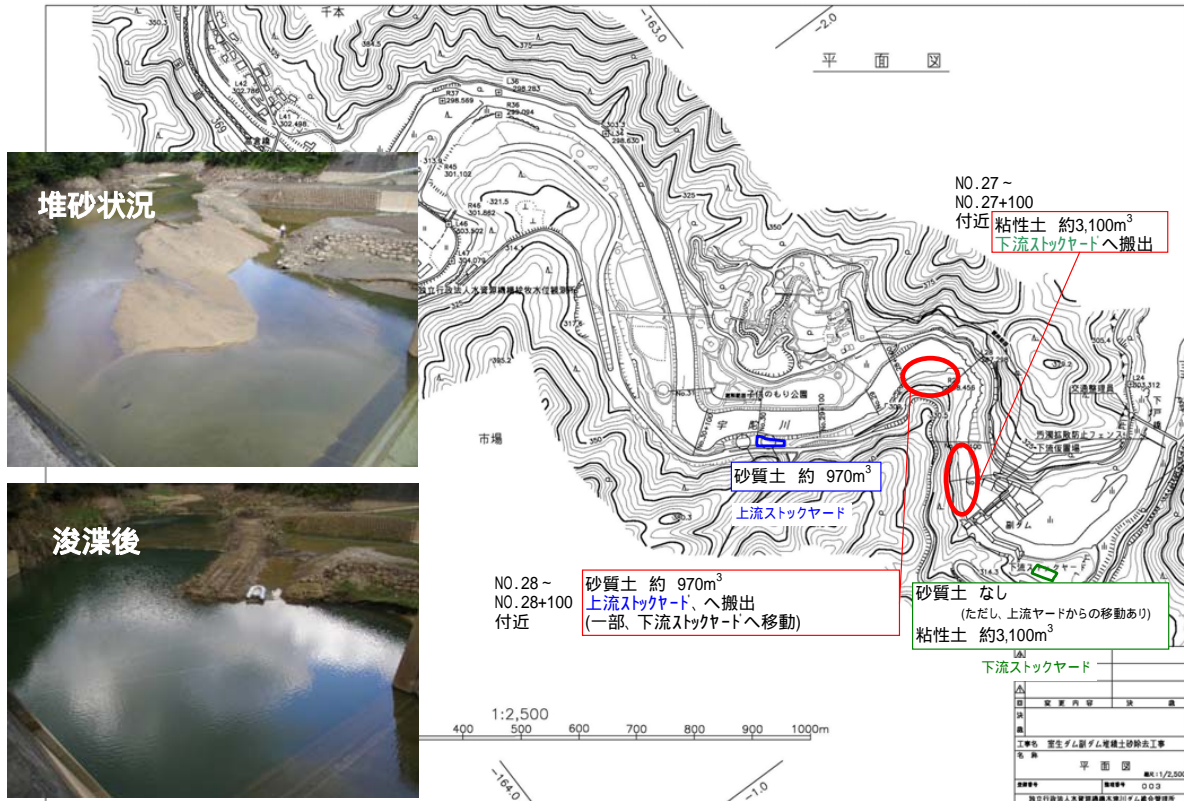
2007(平成 19)年度浚渫工事箇所平面図
